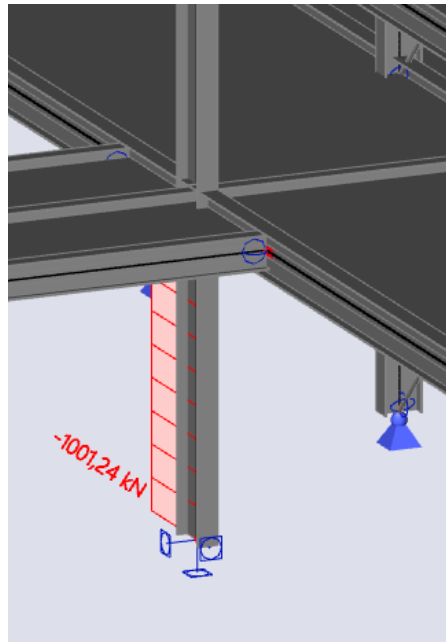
Diagrama de normal do pilar mais solicitado do pavimento térreo.
